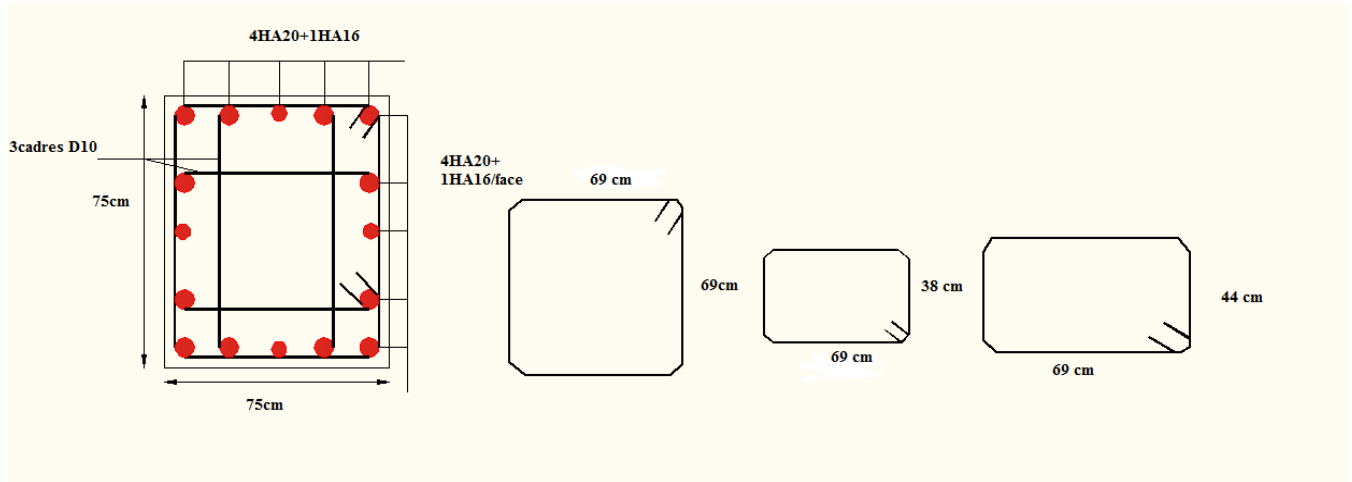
Schéma de ferrailage des poteaux du RDC.
